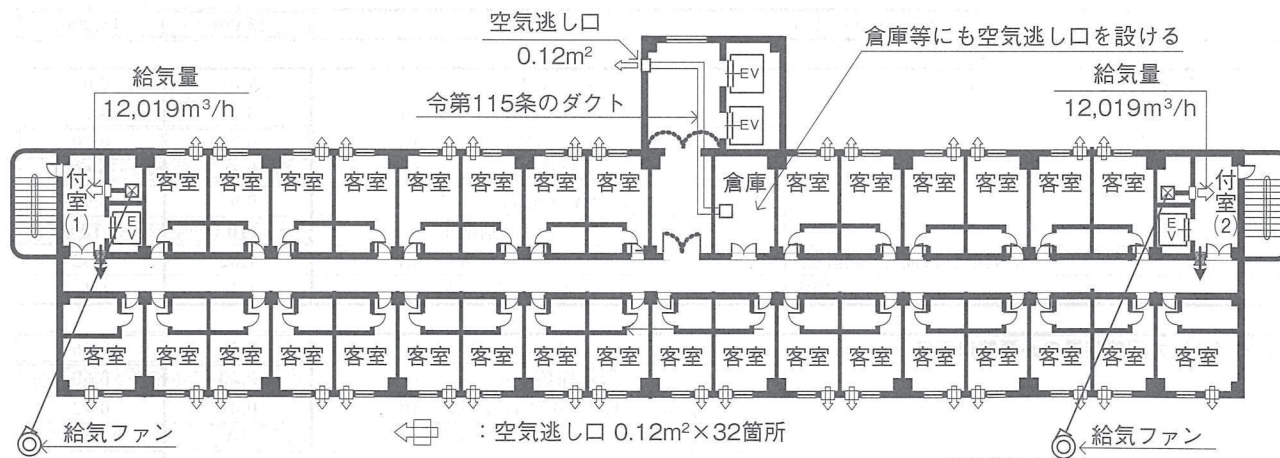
中間コア型2の平面図と加圧防排煙の計画
